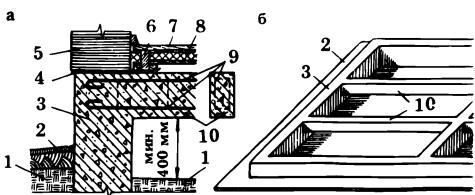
Устройство цокольного перекрытия по железобетонным ригелям
